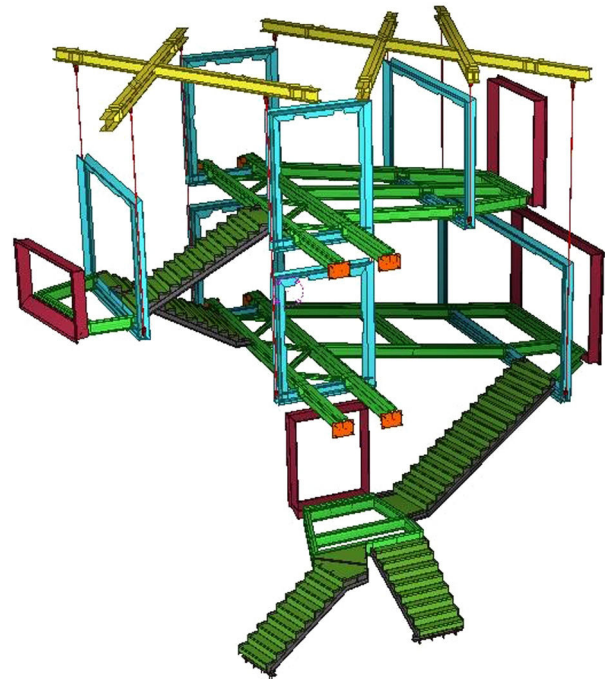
Vista del modelo de Tekla desarrollado para la fabricación de la estructura metálica.
